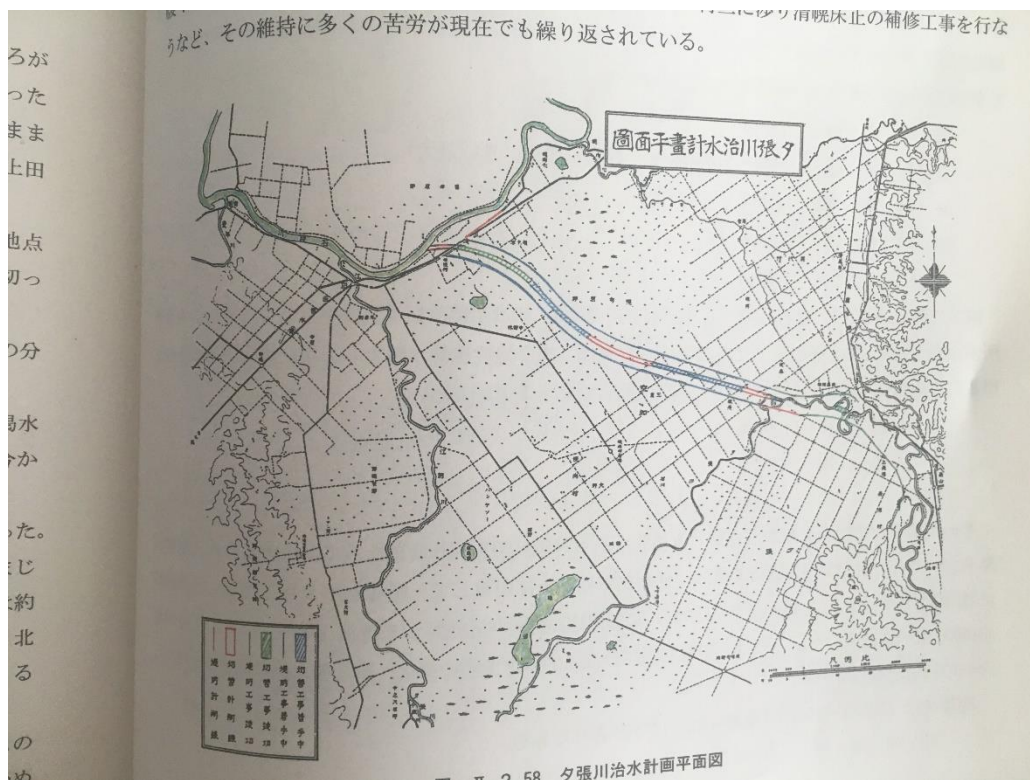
夕張川治水計画平面図 (捷水路³⁾ から)
